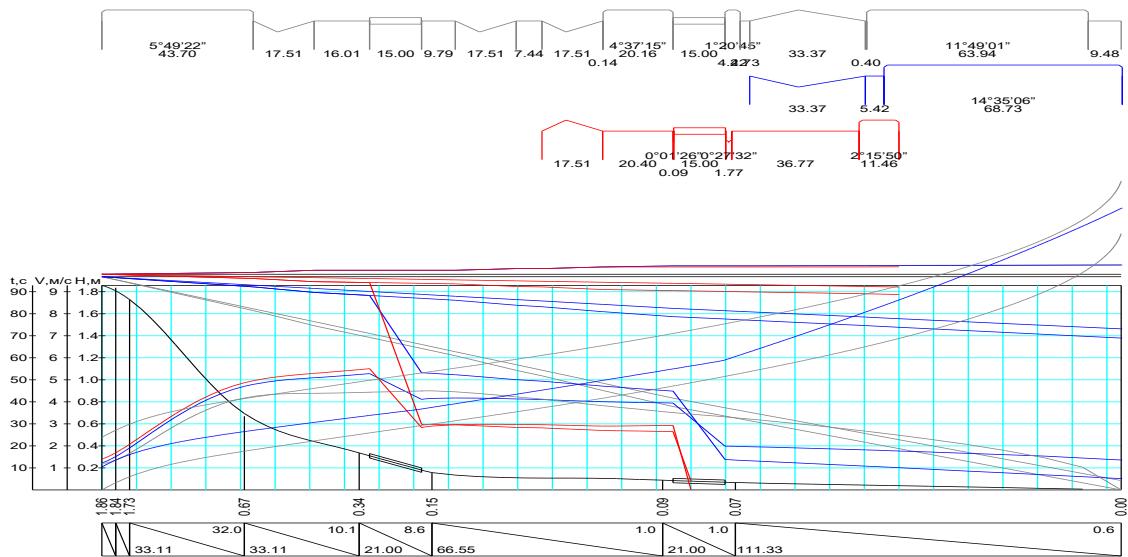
Гладкосопряженный проектный продольный профиль сортировочной горки
